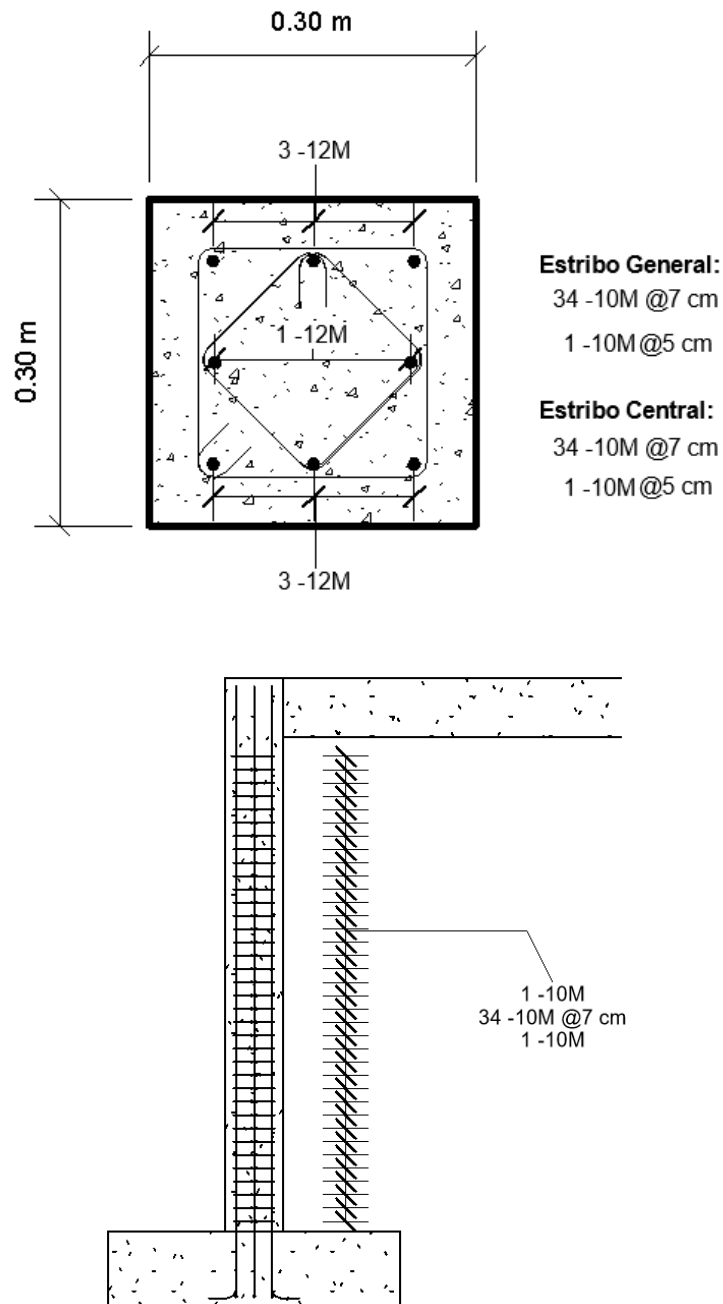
Sección transversal y acero de refuerzo colocada en la columna OMF - 3 pisos
